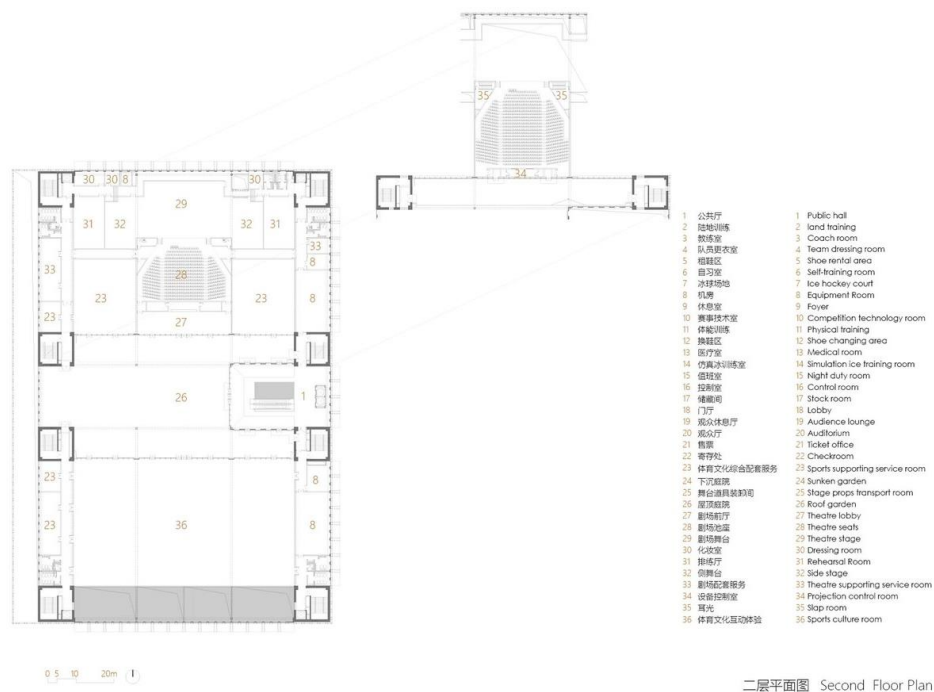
План второго поверху, арх. VIAD-ZXD ARCHITECTS [1]
